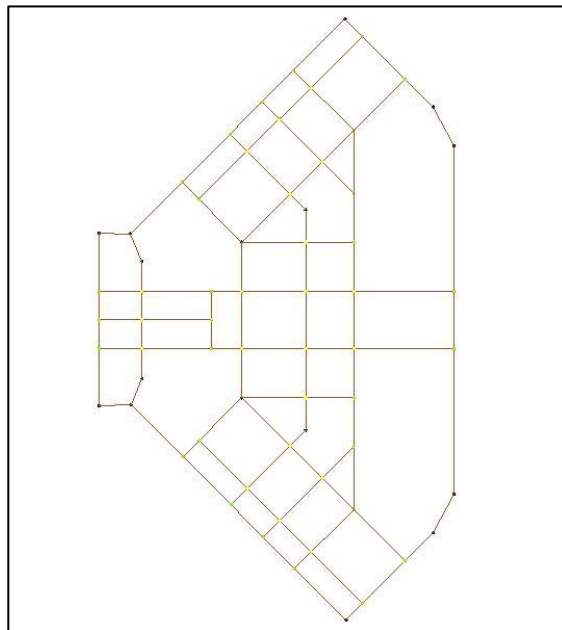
A Vista en planta de las paredes del edificio (Fuente: Propia)
